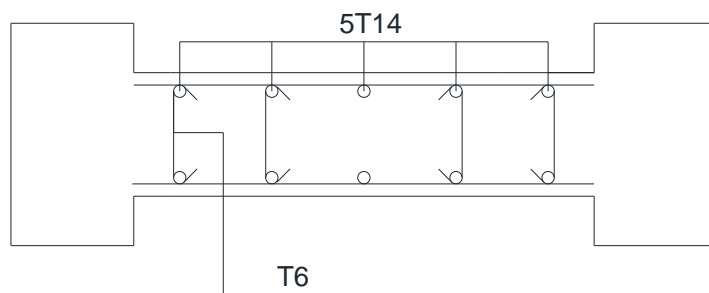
Schéma de ferrailage du voile (poutres normales - bâtiment R+7)
